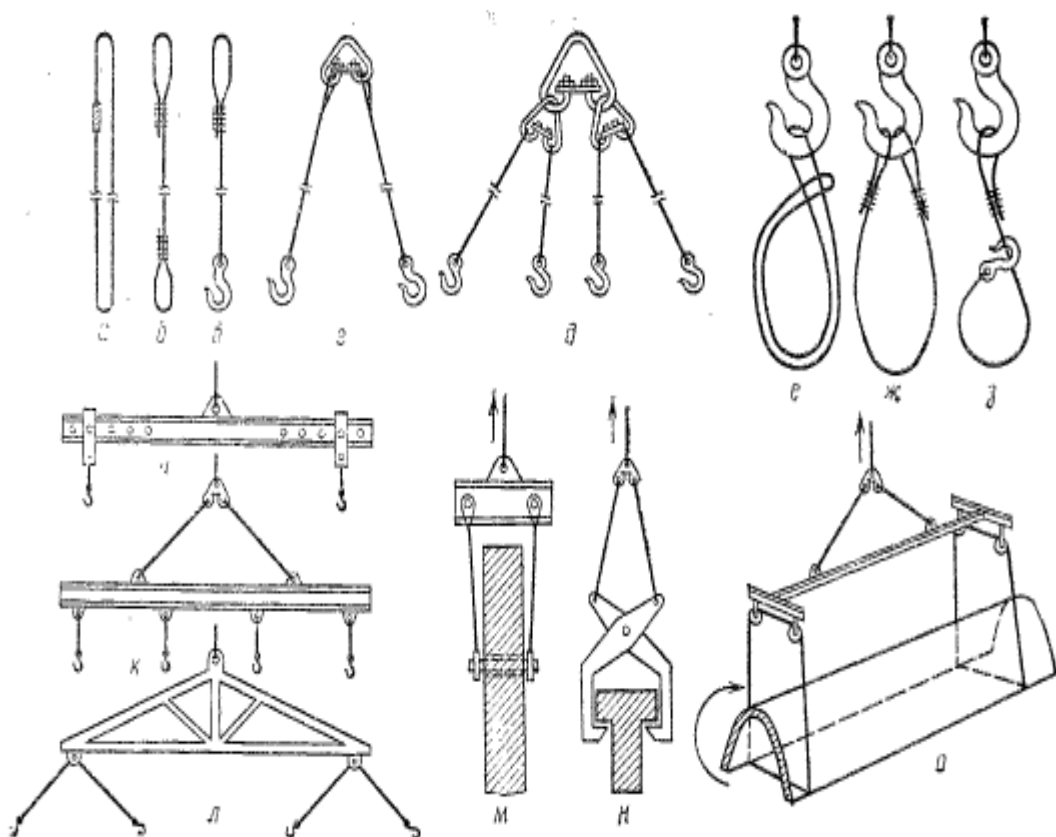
Хватные приспособления для монтажа сборных конструкций:
